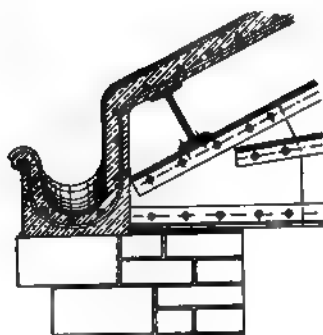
Eisenbetonrinne an eisernem Tragwerk.
